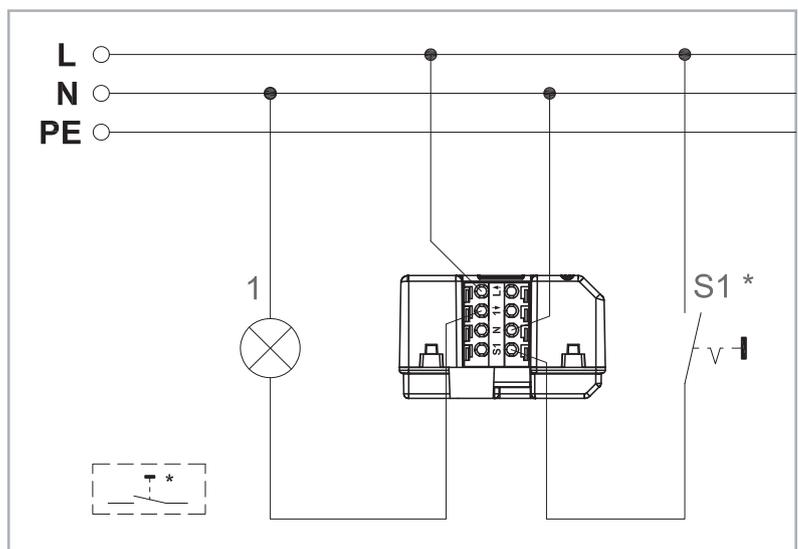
Das Anschlussschema des HmIP-FSI16 mit Schalter oder Wippen-Taster
